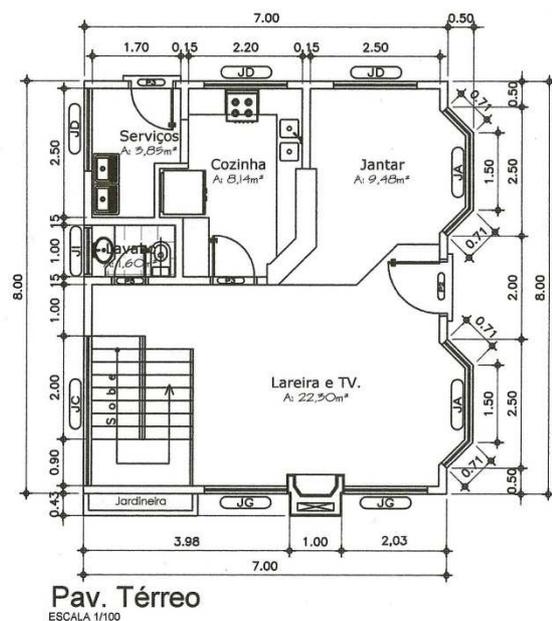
Planta baixa do pavimento térreo para confecção da maquete e aprendizado de conteúdos de matemática.
